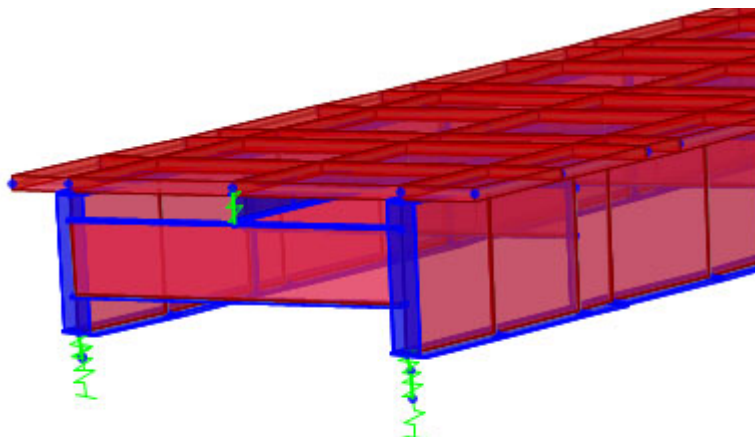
Particolare modellazione collegamento impalcato-sottostrutture con link rigidi ed isolatori
